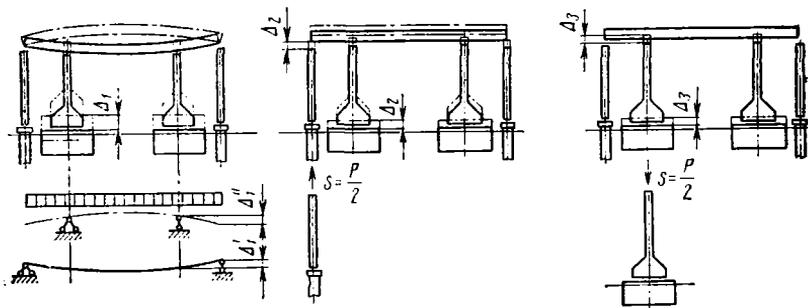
Схемы к определению деформаций, учитываемых при расчете веса рабочего балласта
